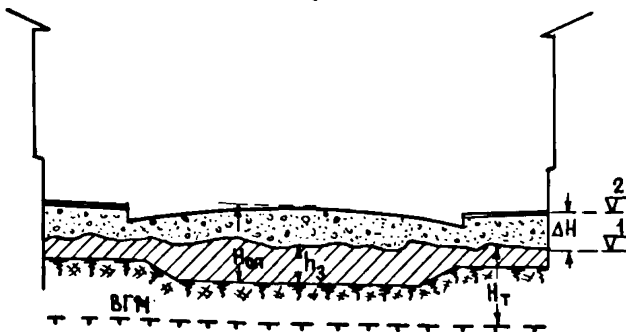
Улица с заменой грунта в основании дорожной одежды: 1 - черная отметка (до планировки участка); 2 - красная отметка вертикальной планировки
